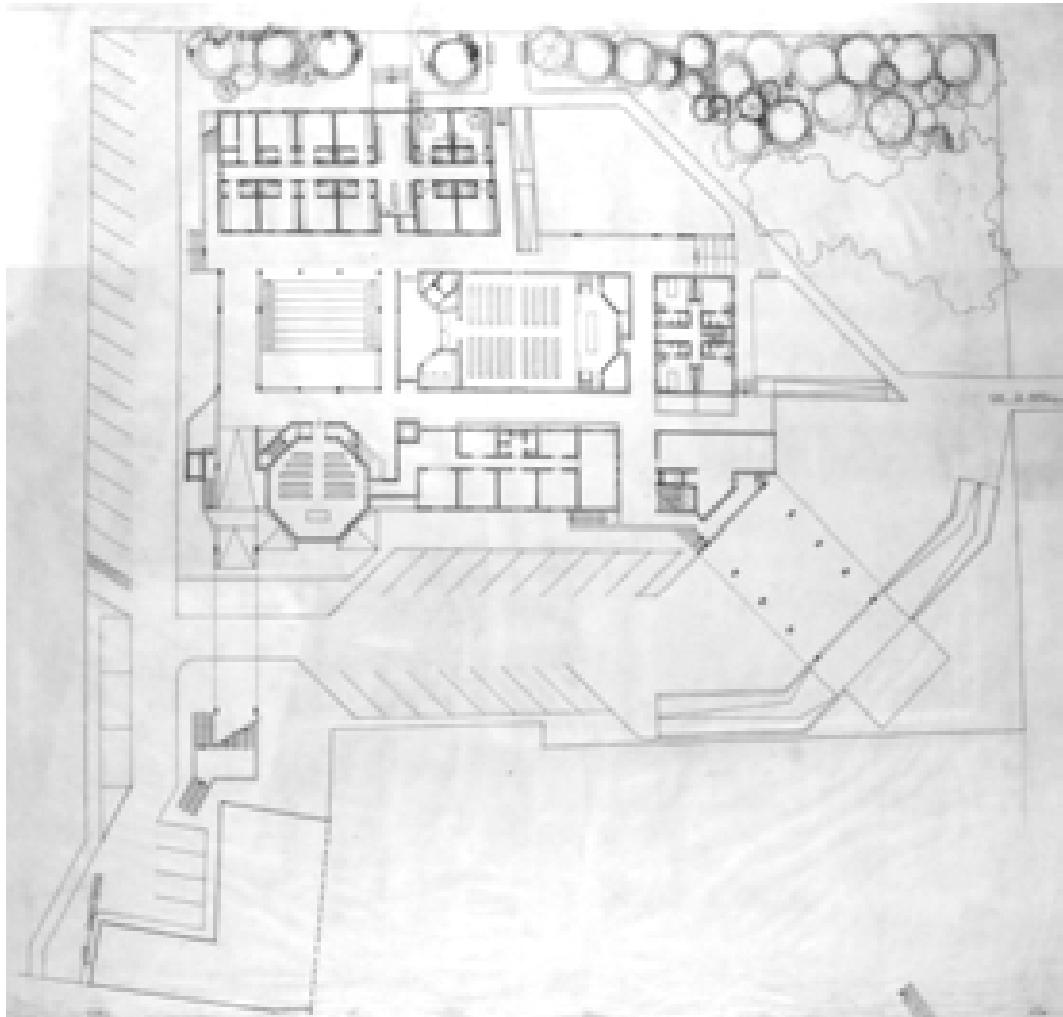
Pianta sistemazione esterna, stato futuro – 25/05/1993 (AABS-64_380)
